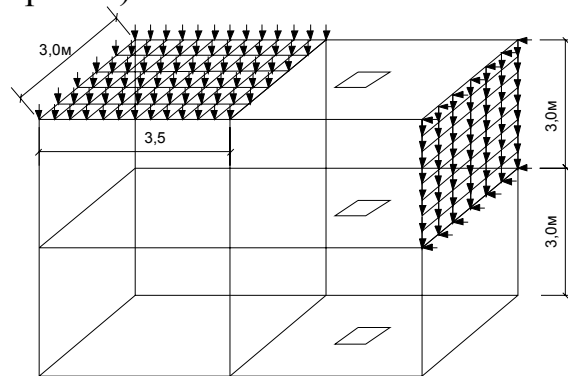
Розрахункова модель окремого блоку пластинчастої будівлі з поділом його на скінченні елементи, розмір елемента 0,5х0,5 м. Умовно показаний поділ тільки двох панелей (вертикальної і горизонтальної)
